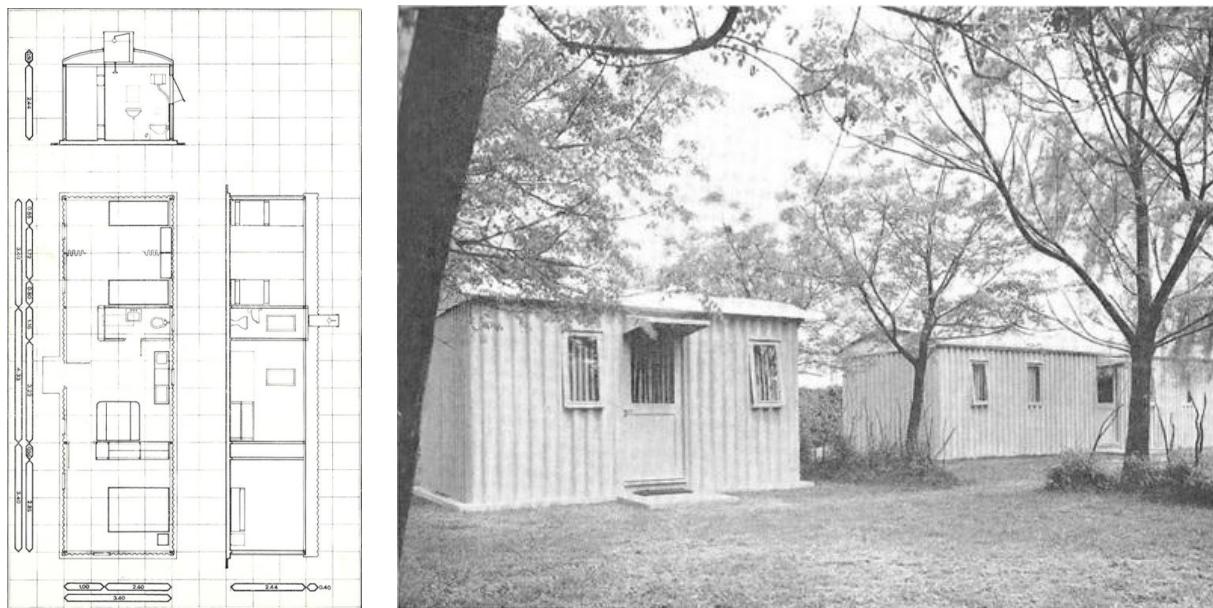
Planta, cortes y fotografía de la vivienda mínima decente / Plan, sections and pictures of Vilar's "vivienda mínima decente". Reproducción de /reproduced from Scarone, Mabel M.. Antonio U. Vilar. Instituto de Arte Americano. Buenos Aires, 1972
